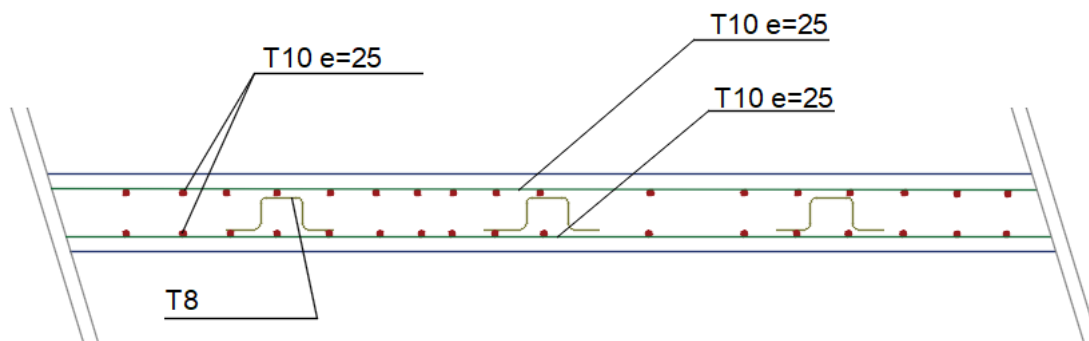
Coupe transversale au niveau de la dalle pleine.
